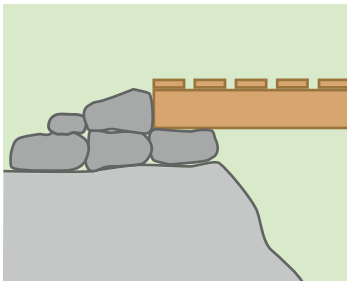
Spalla realizzata con blocchi di pietra
